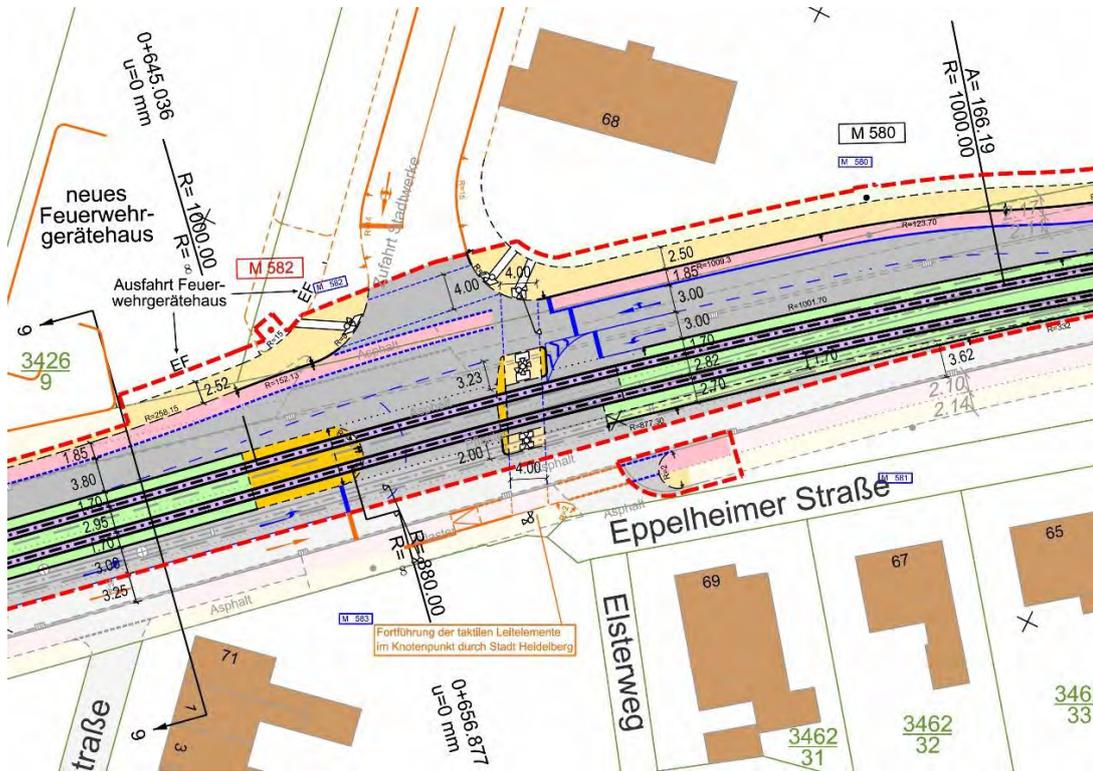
Vorabzug Lageplan Planung Anschluss Stadtwerke<sup>14</sup>
